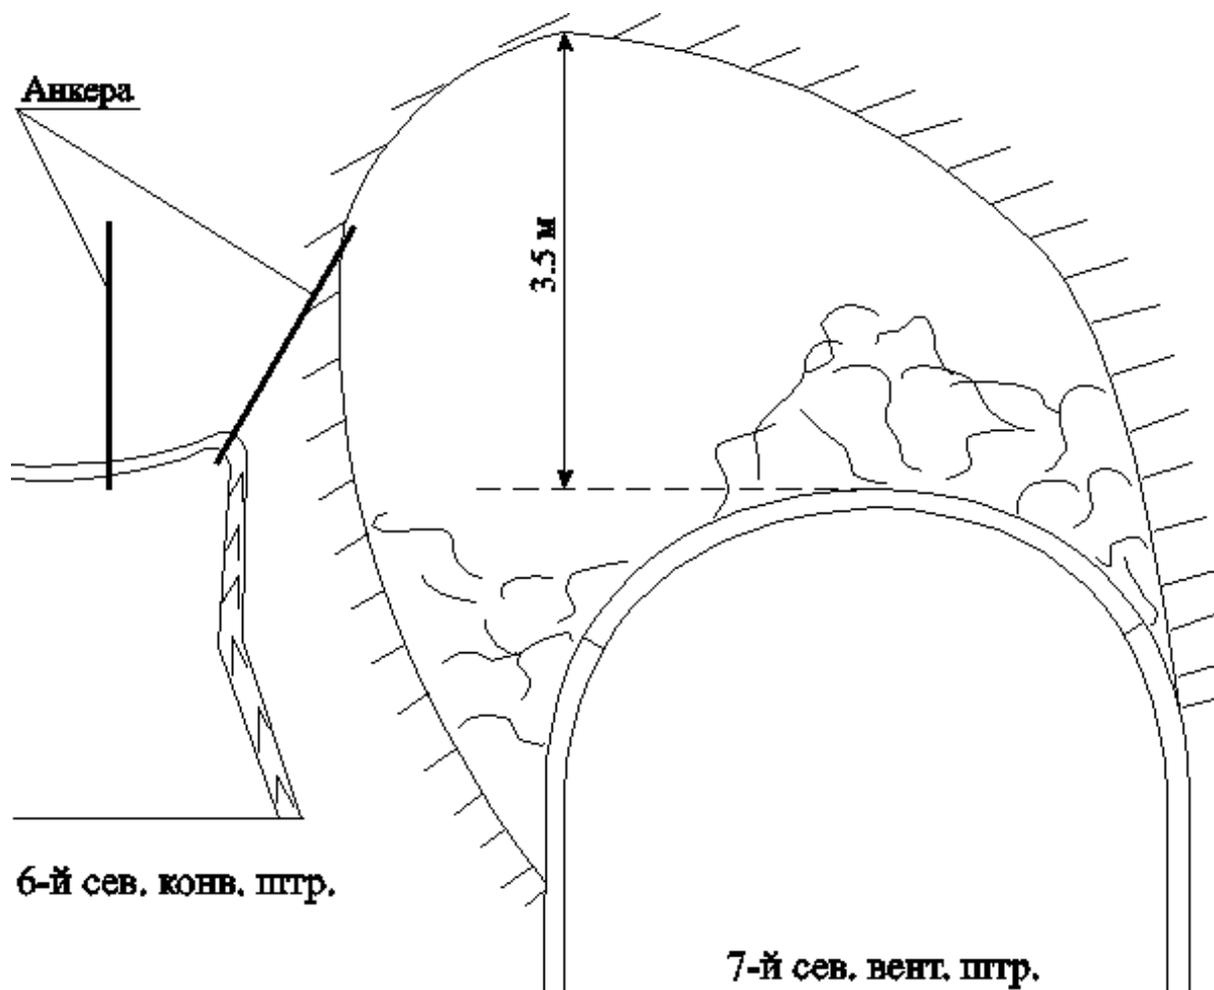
Эскиз поперечного сечения купола обрушения пород кровли в забое 7-го северного вентиляционного штрека
